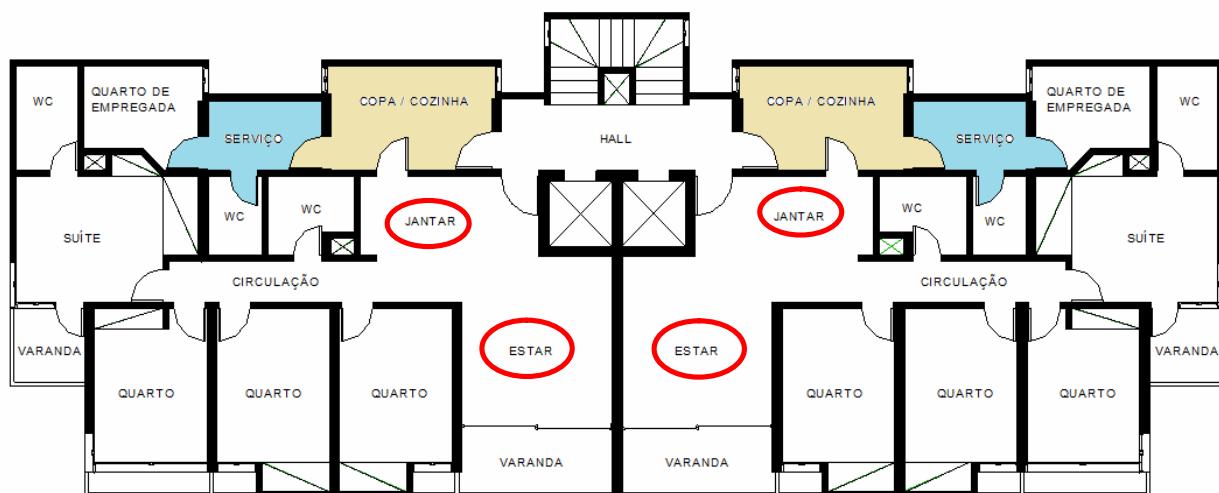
Planta baixa do pavimento tipo do edifício Rocas
